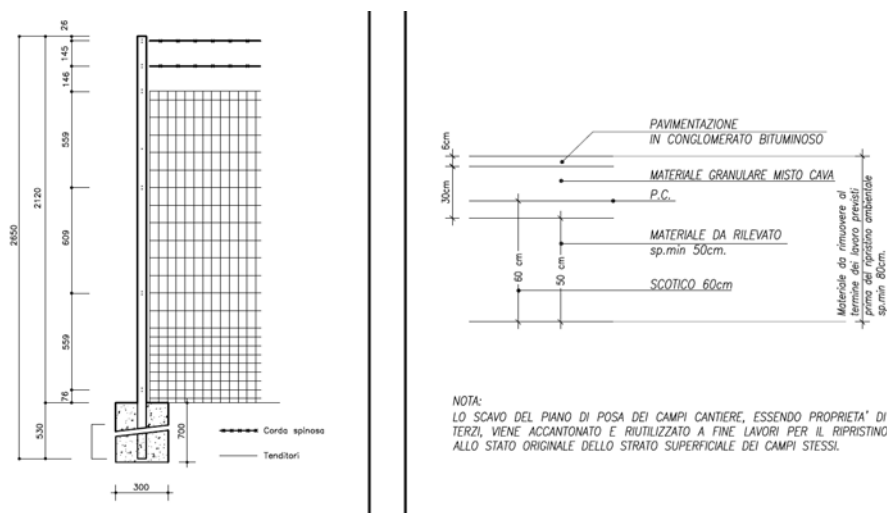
particolare della recinzione (a sinistra) e del pacchetto di pavimentazione previsto per il piazzale (a destra)
